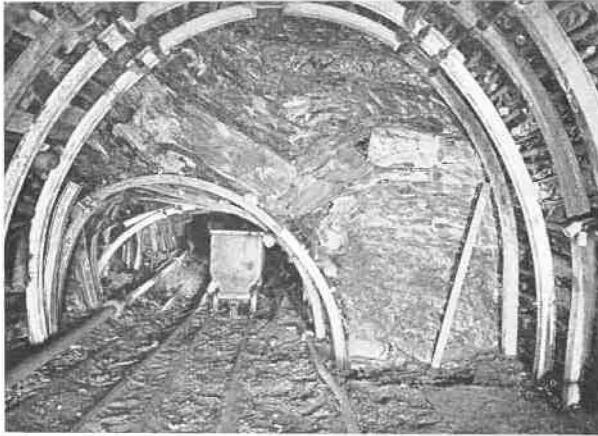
Vue du recarrage dans la voie revêtue de cadres Toussaint-Heintzmann placés sans semelle sur la roche.
